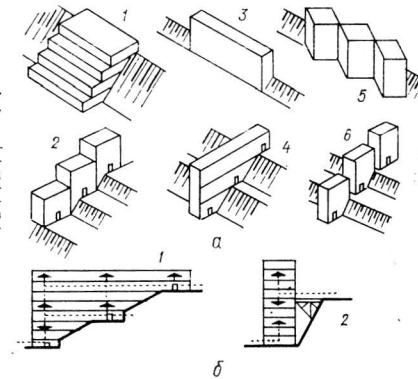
Размещение и типология зданий для застройки на крутых склонах:
